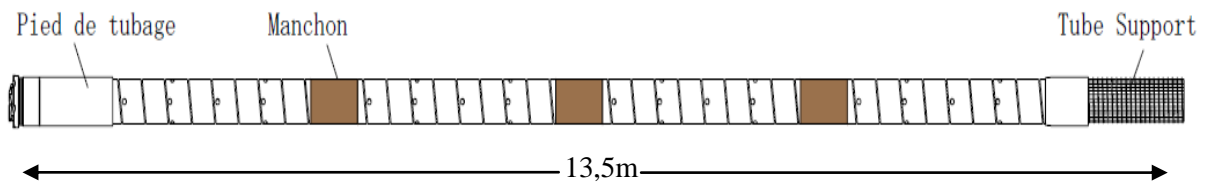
Assemblage des tubes « GFRP », L=13.650 m.
